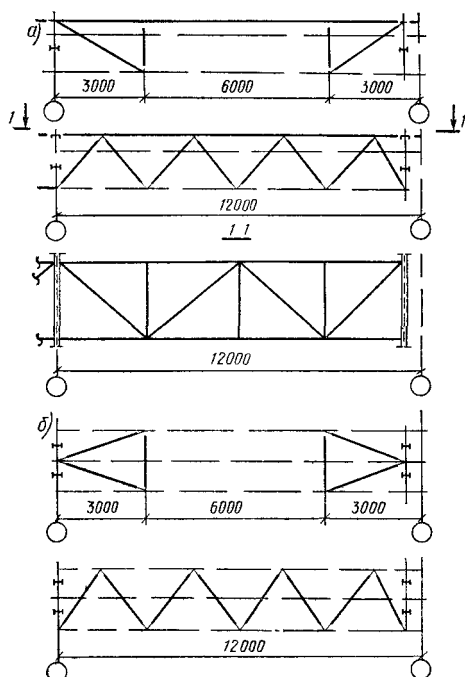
Схемы связей по нижним поясам подкрановых балок
